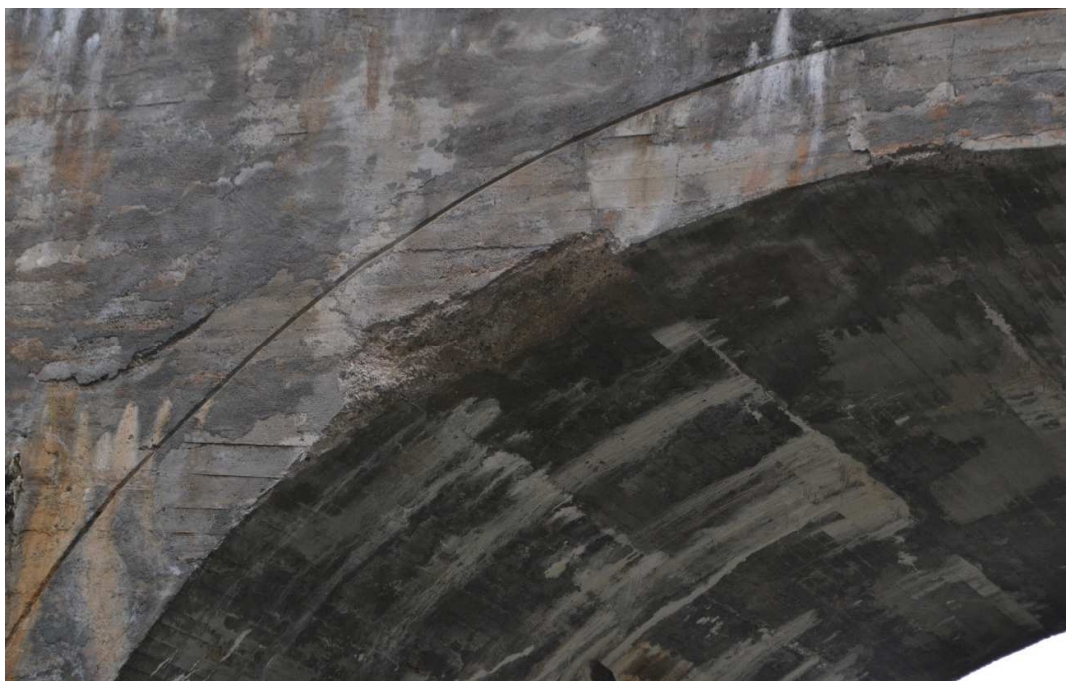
Razpadanje betona na stiku ločne konstrukcije in podpornika
